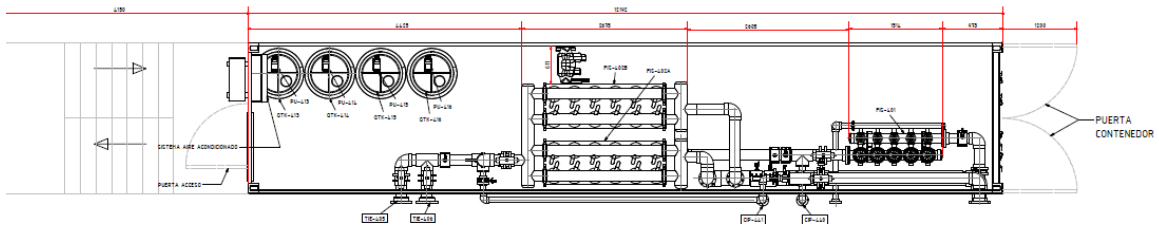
Contenedor II Fuente: Proyecto Planta desaladora GO (Entregada por la empresa)
